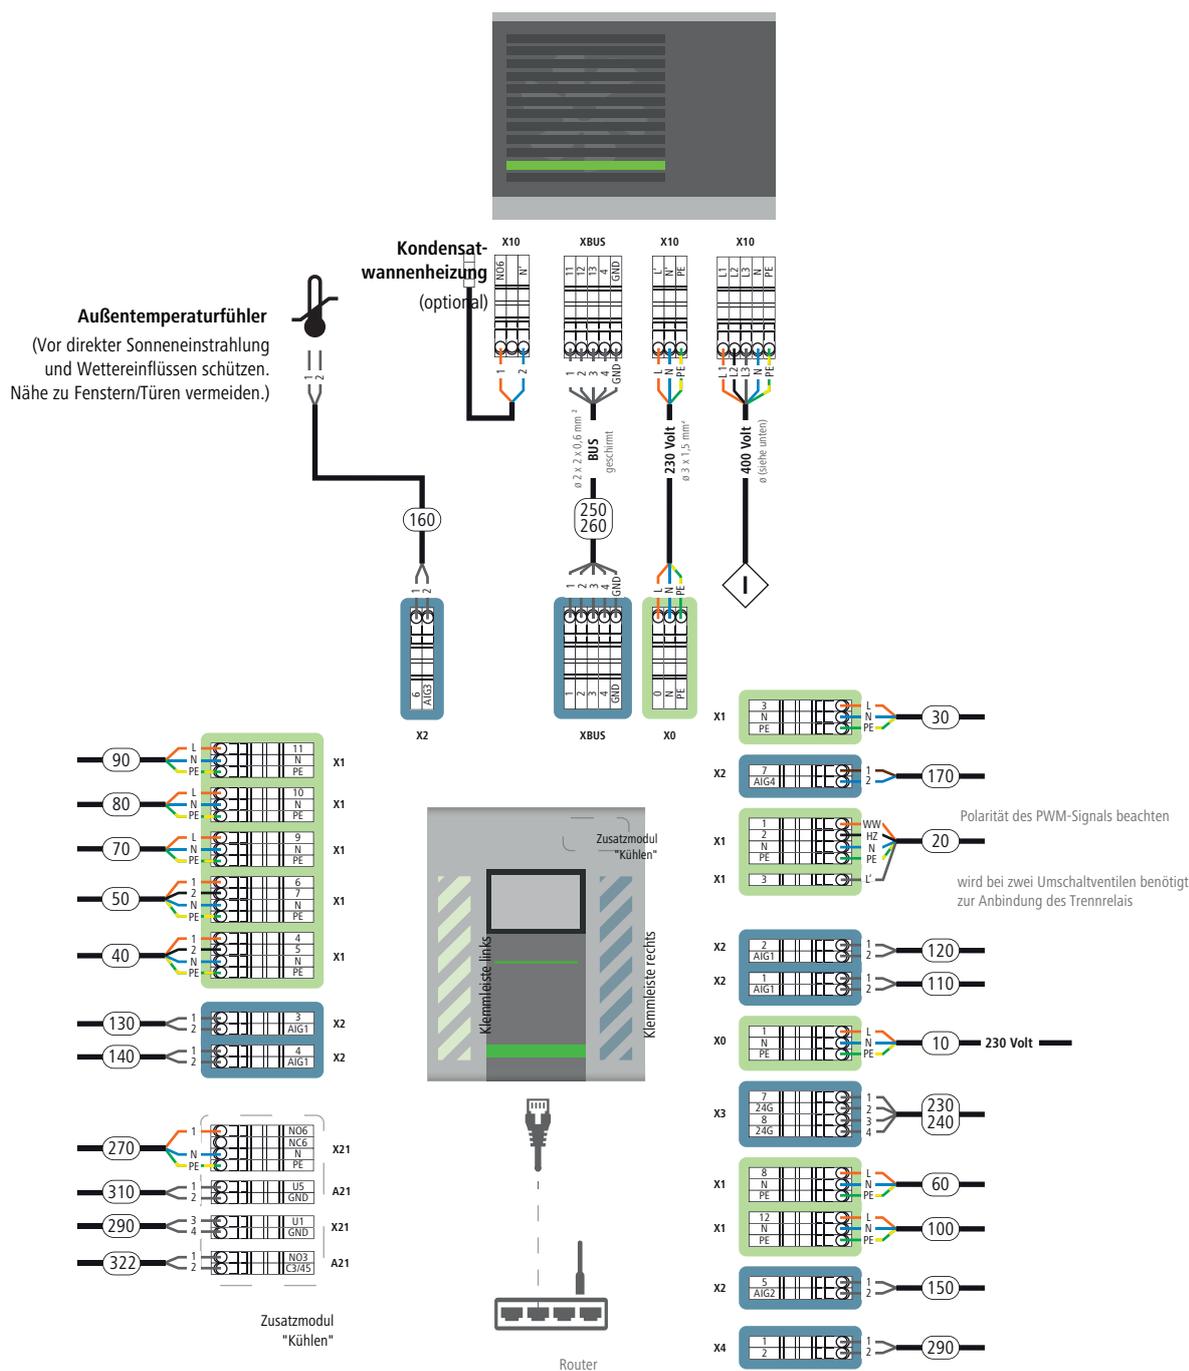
Elektroinstallationsplan mit Speicherkombination
